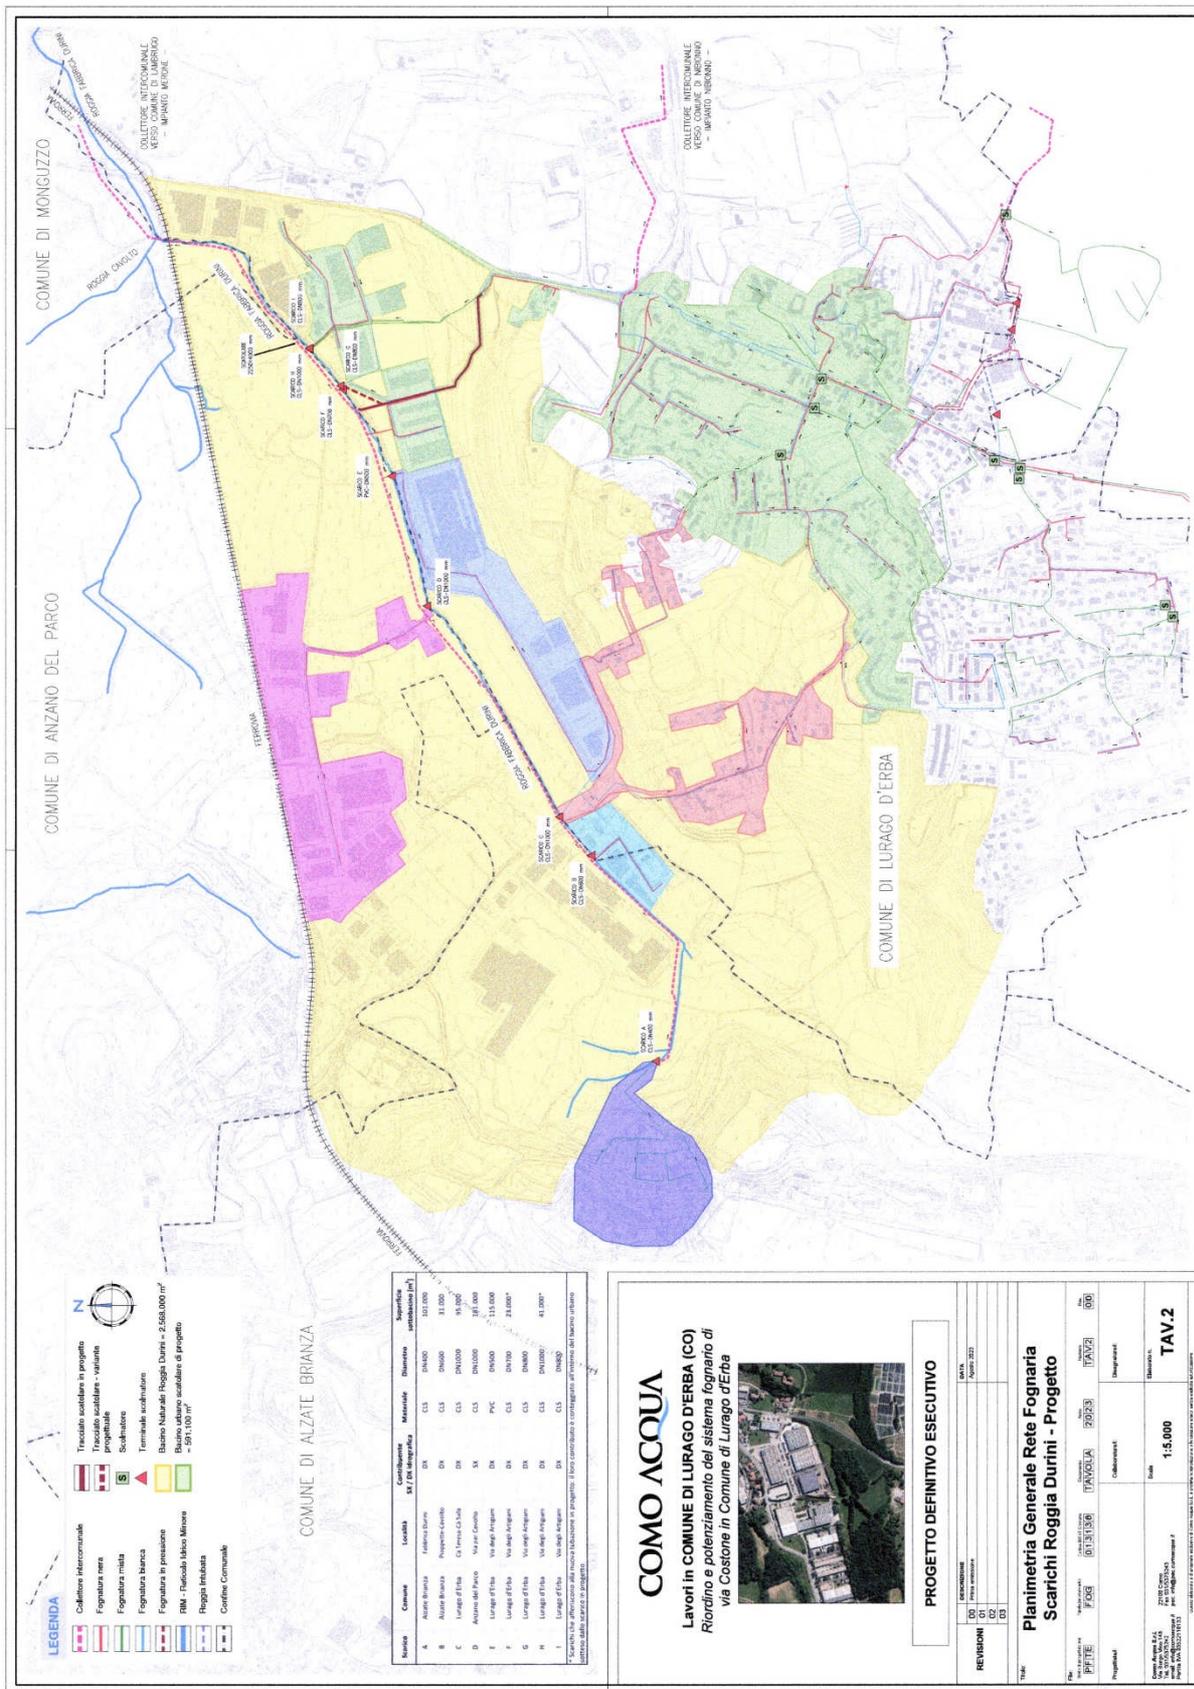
Progetto Rev. 09/2023 – Planimetria generale scarichi Roggia Durini – Progetto
